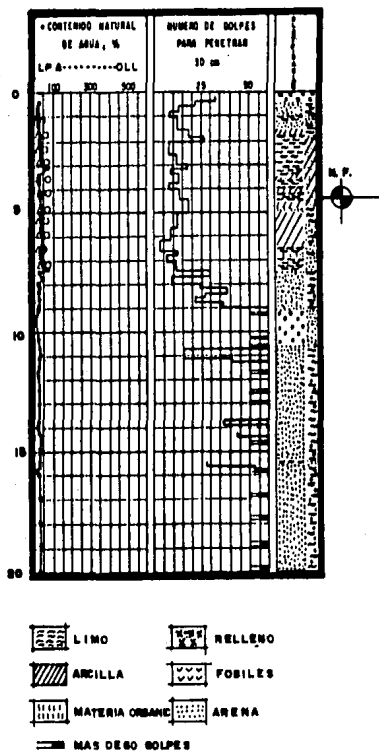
SONDEO DEL TRAMO DE TUNEL QUE COMPRENDE A LA ESTACION TACUBAYA DEL METRO.
